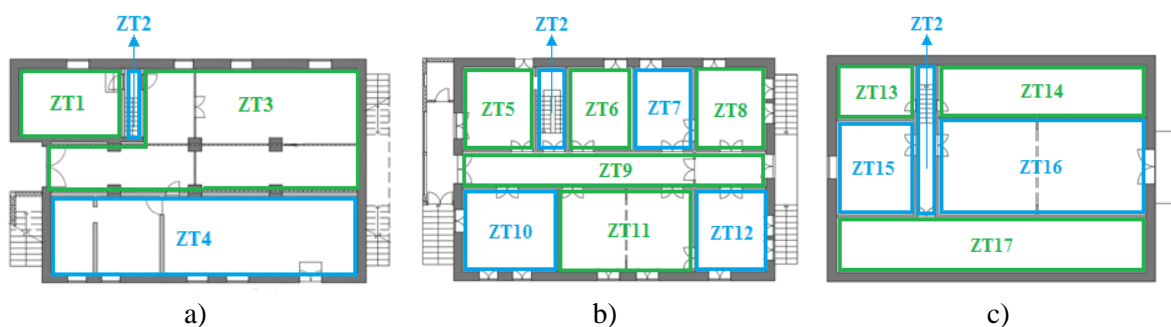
Identificação das zonas térmicas. a) Planta do r/c; b) Planta do 1º andar; c) Planta do sótão.
